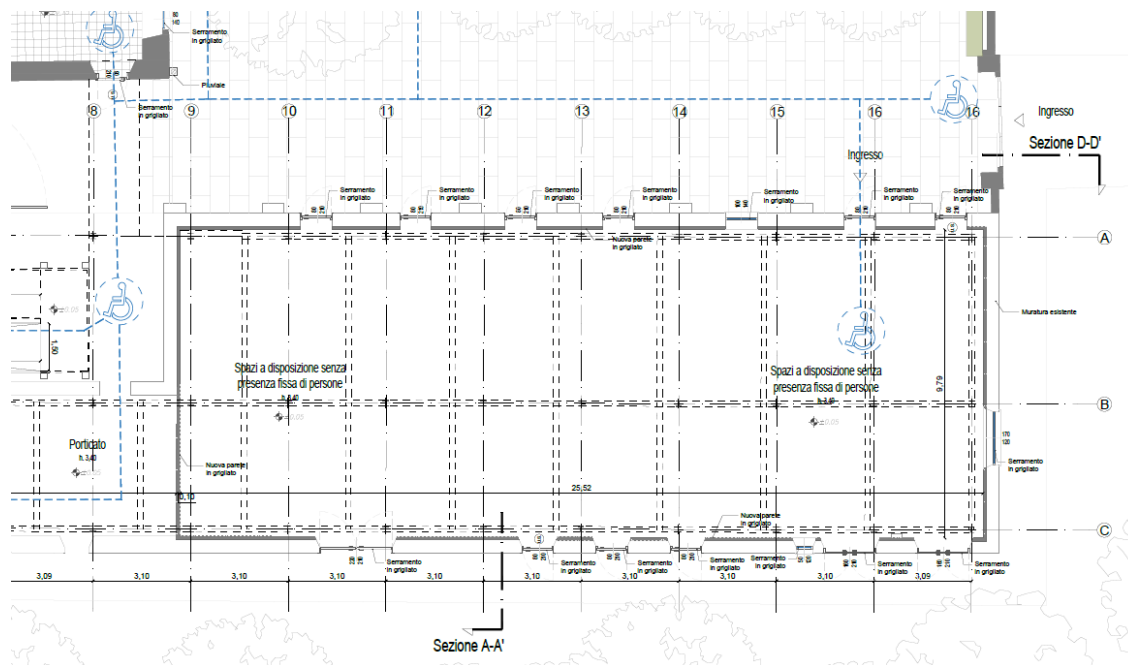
Ex-Galoppatoio - pianta piano terra Terrazza
